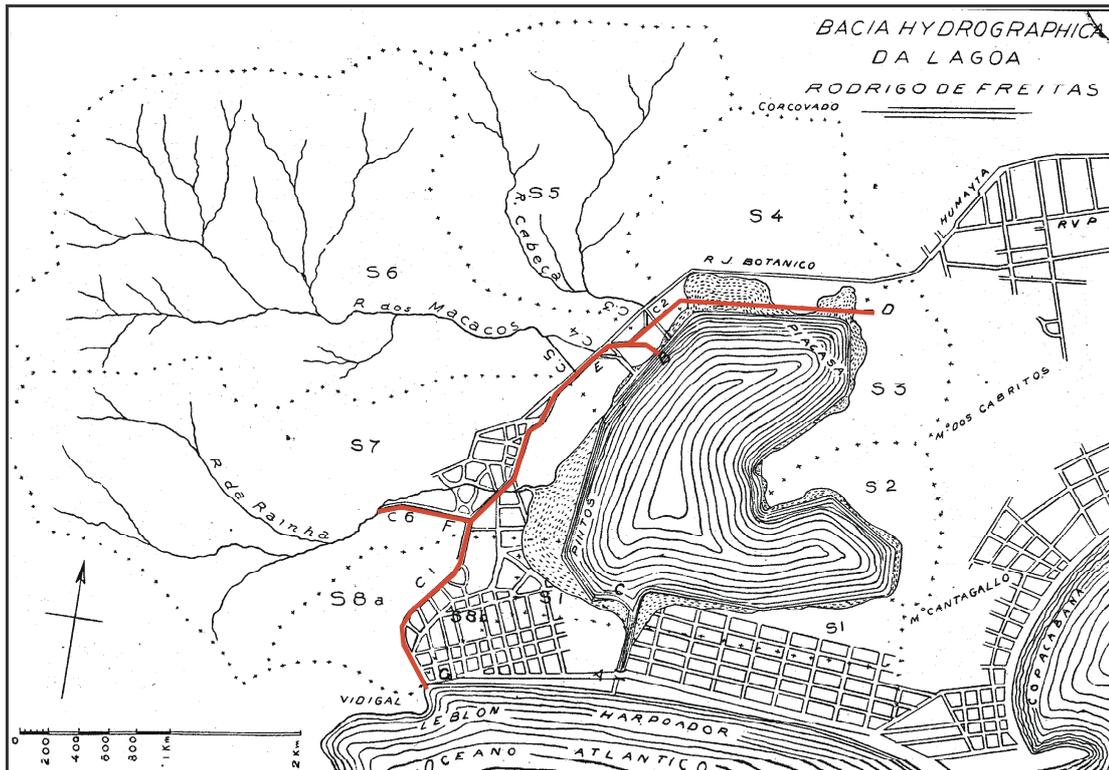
Planta do canal interceptor (Estudo 1).<sup>2</sup>
